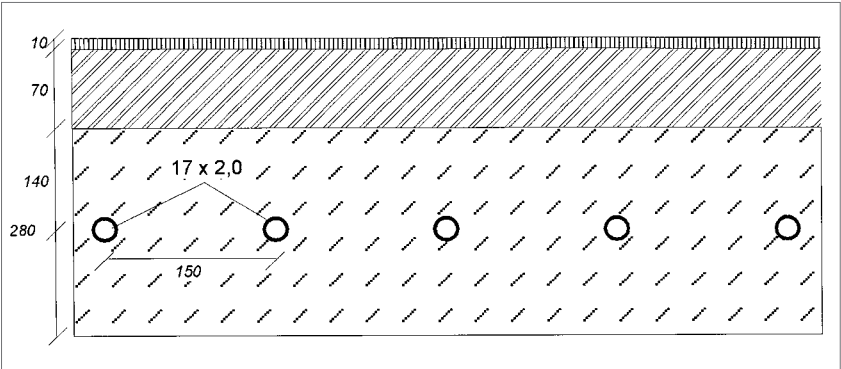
混凝土楼板结构采暖与制冷系统天花板结构截面图
